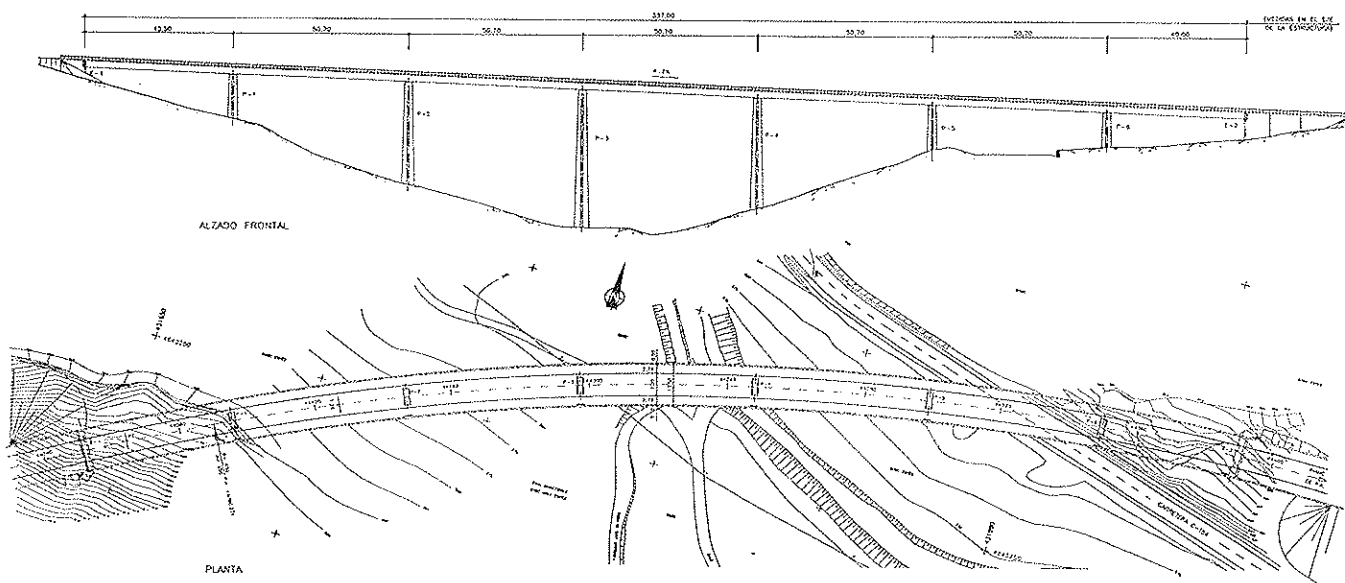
Viaducto de Sant Bartomeu. Alzado y planta general.
